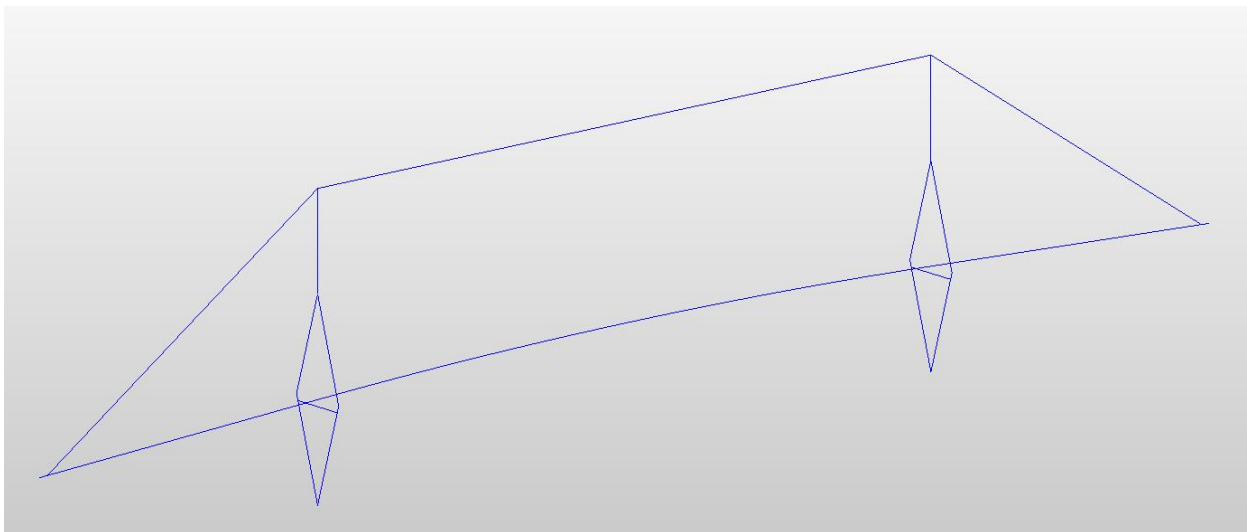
Geometría sistema de rigidización longitudinal 1 en estructuras atirantadas según un solo plano central
